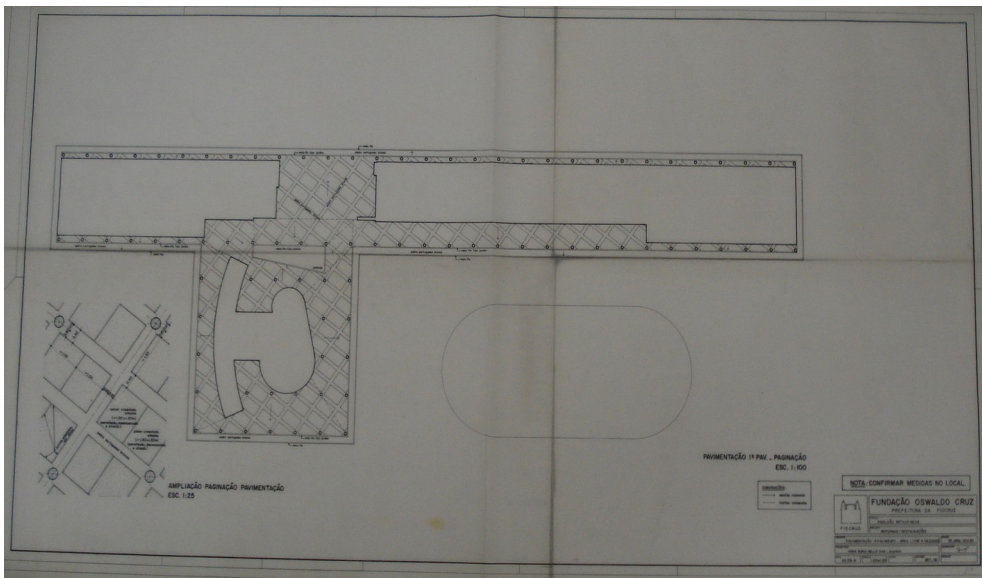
Planta pavimentação 1º pavimento. Projeto de reforma / restauração. 1991. Acervo DAD/COC/FIOCRUZ.
